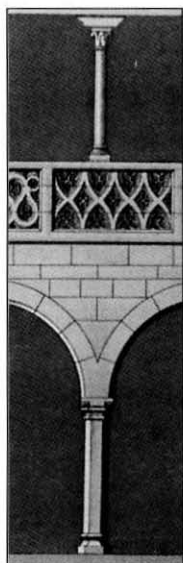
Detalle Lado A según López Sánchez (1878).
